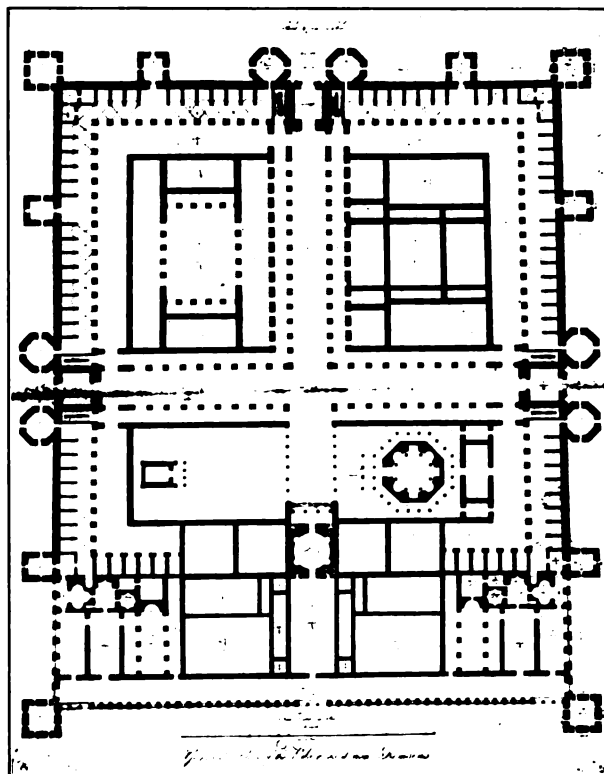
Spalato, Diokletianspalast: Grundriß (nach Ribam)
